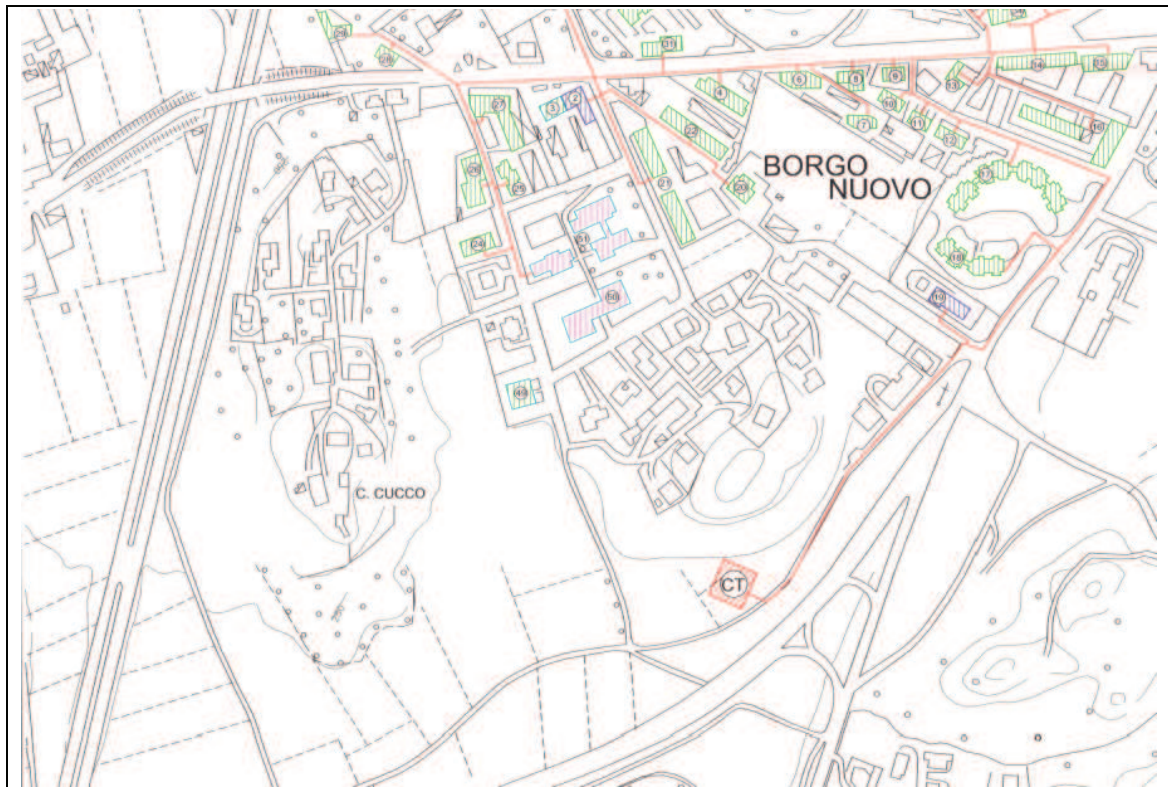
Schema rete teleriscaldamento con indicazione dell'ubicazione della centrale termica.
